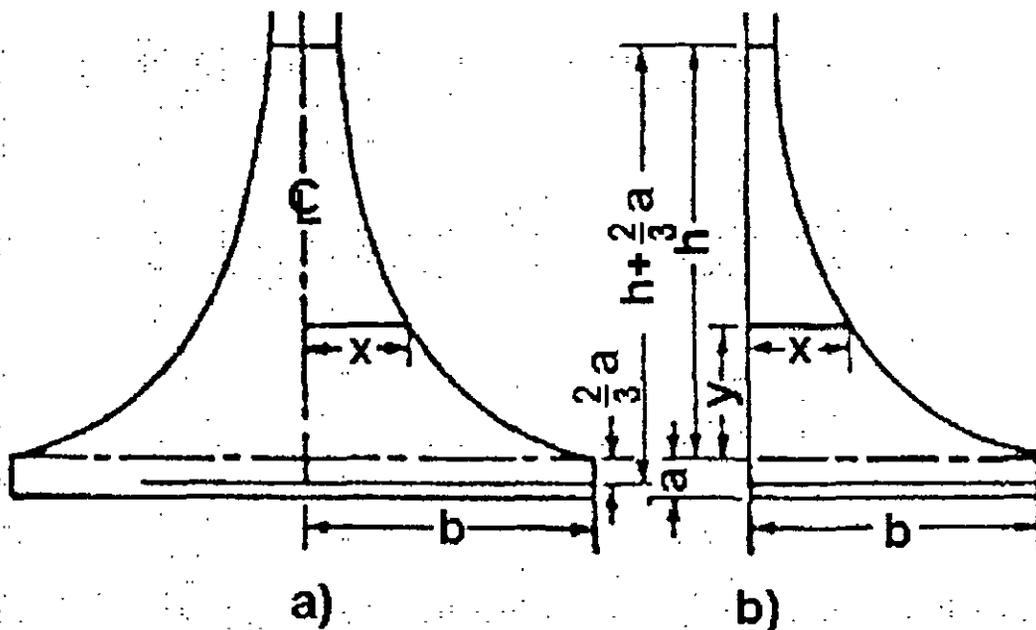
Elementos de un vertedor proporcional (a) y de un vertedor tipo sutro (b)
